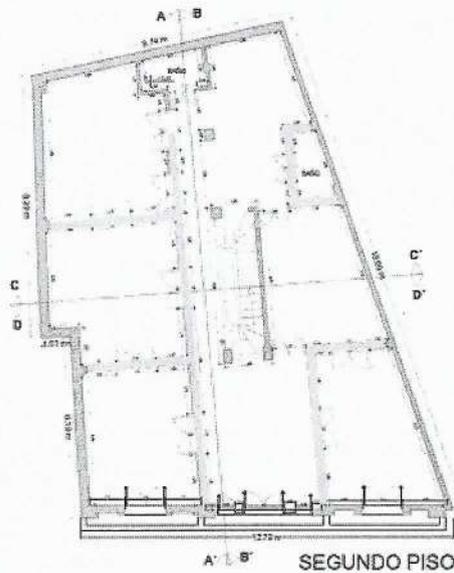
Plano de levantamiento (muros propuestos a demoler)
